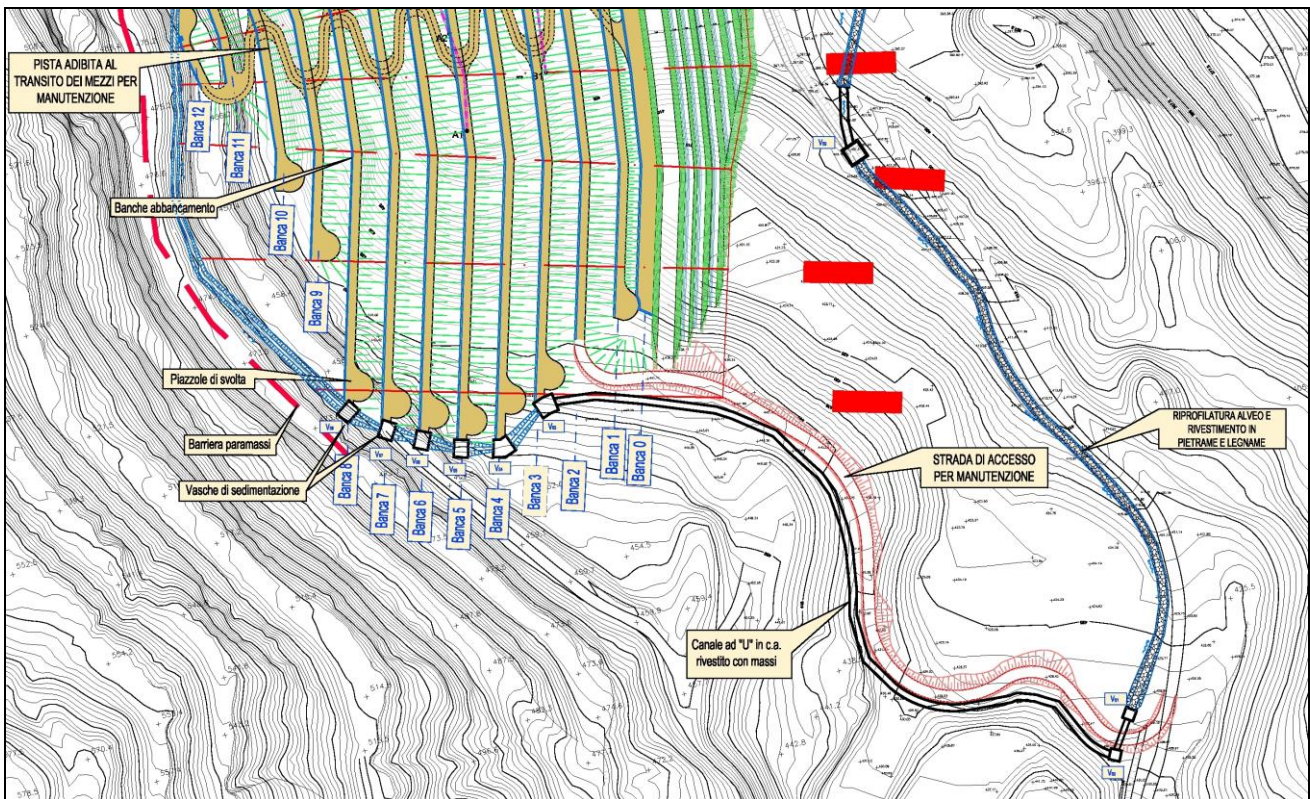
Viabilità di accesso abbacamento – Planimetria
